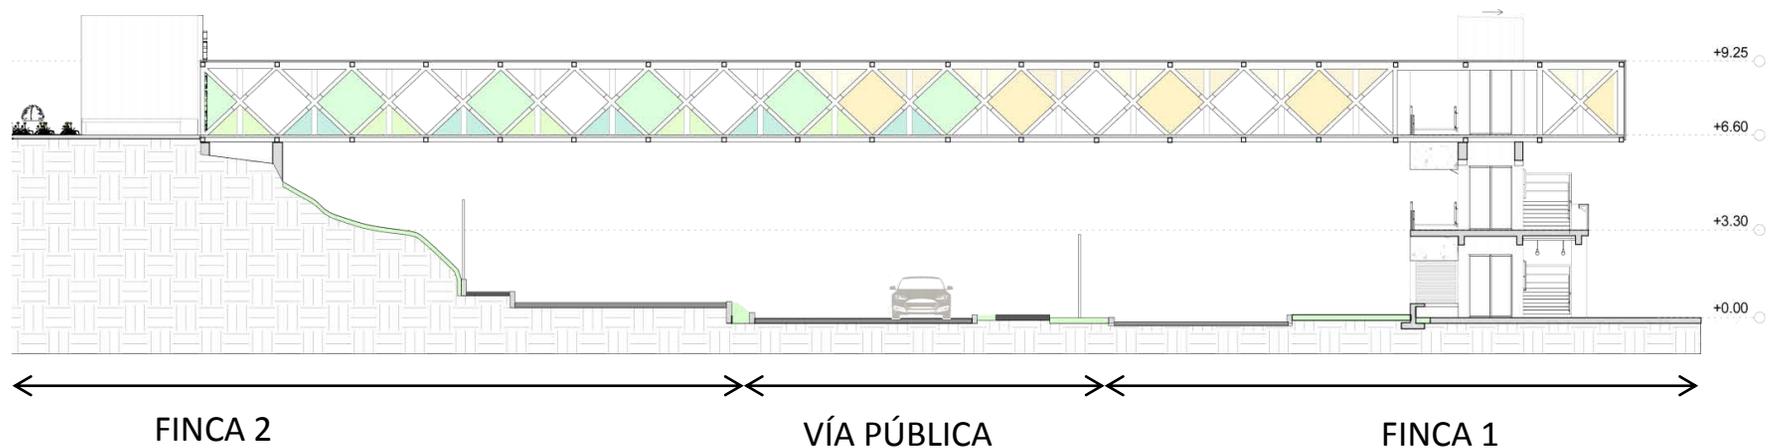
Articulador Finca 1 y 2. Autoría propia
